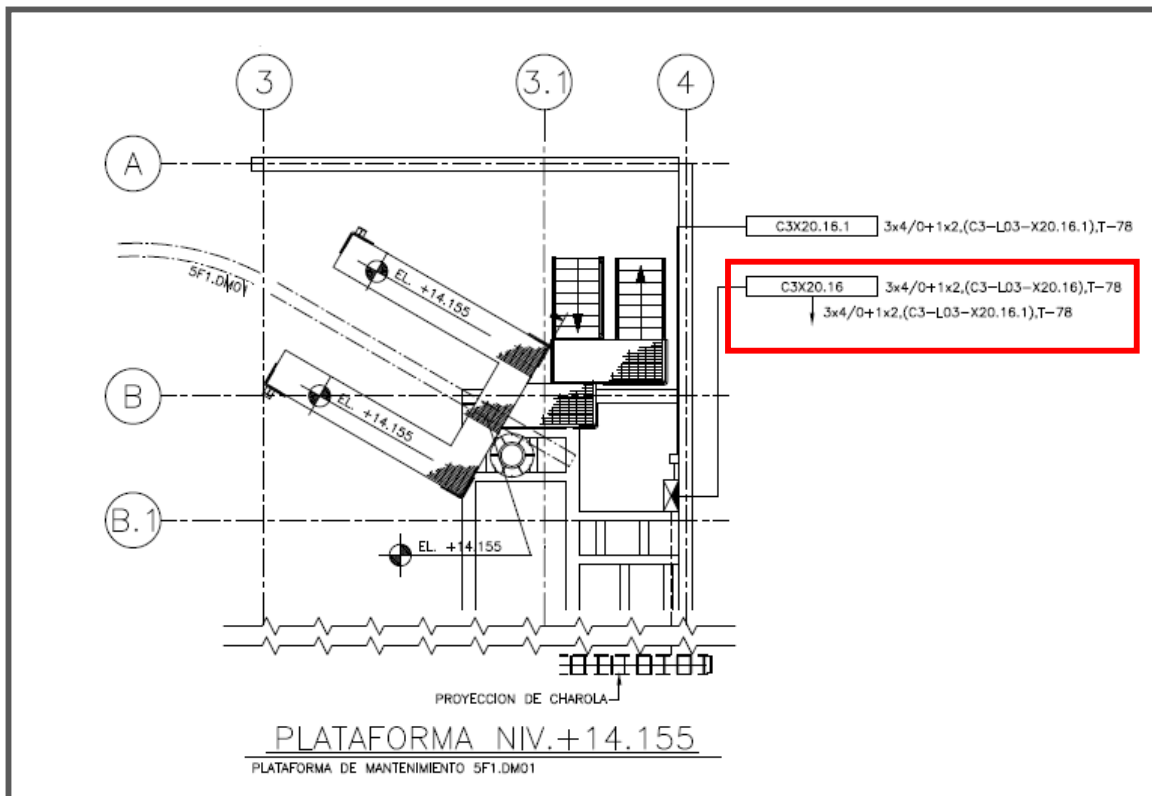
Ubicación de caja en ingeniería de detalle.
